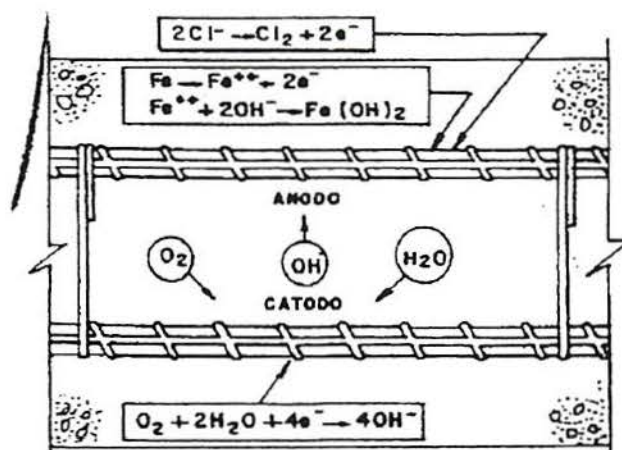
Formação de uma pilha de corrosão em armadura de concreto.(6)
